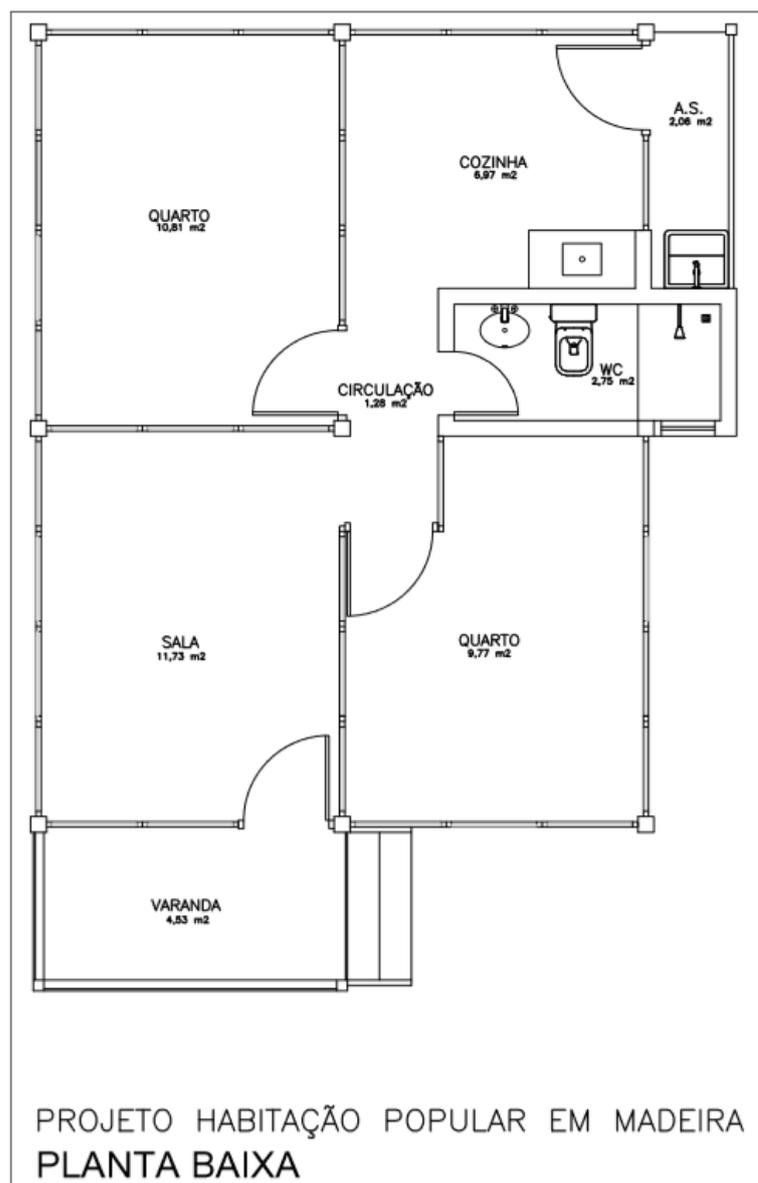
Planta baixa do projeto "Habitação Popular em Madeira", escala 1:50
